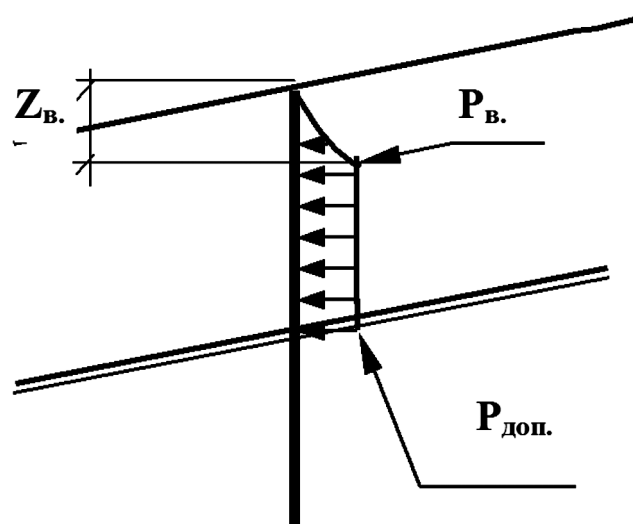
Эпюра давлений на сваю от оползающего грунта во 2-й фазе
